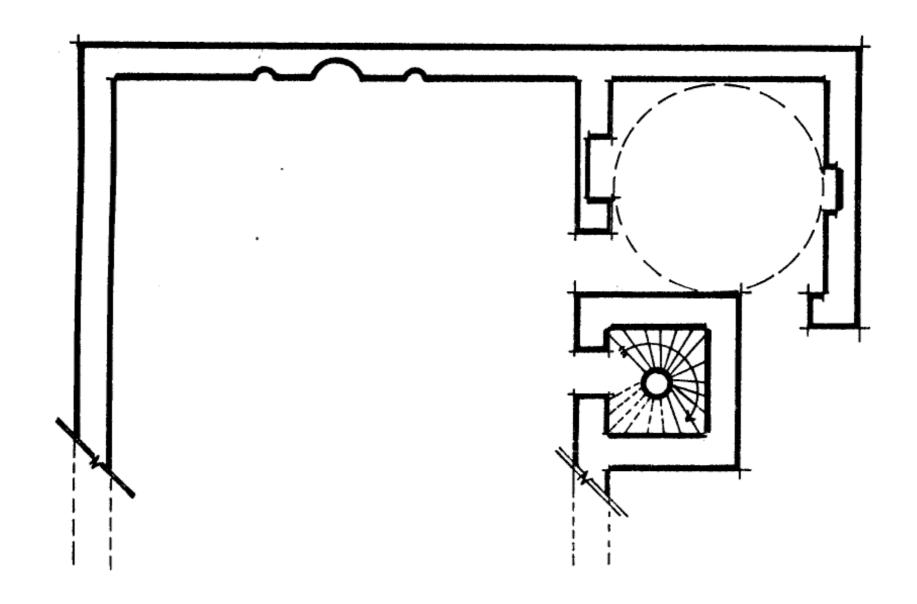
مسقط أفقى لمسجد آلتي برمق (مغياس الرسم ٢٠٠/١)
